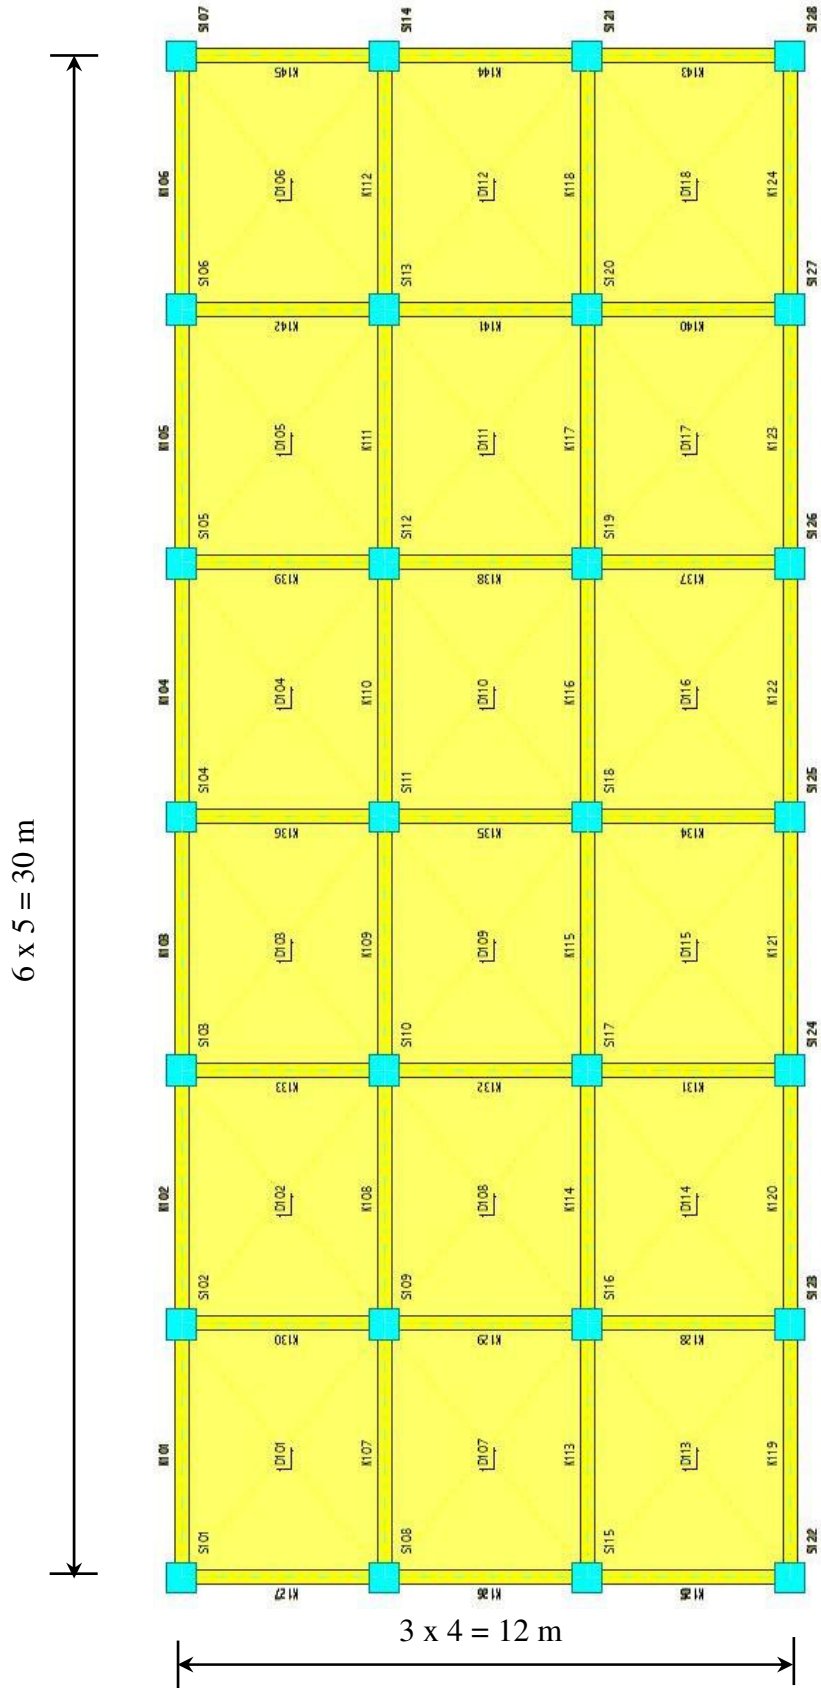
4 açıklıklı binalara ait tipik kat planı
